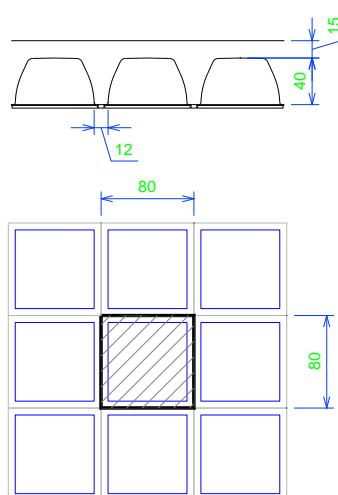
Corte e planta da laje nervurada adotado para o cálculo da lâmina média
